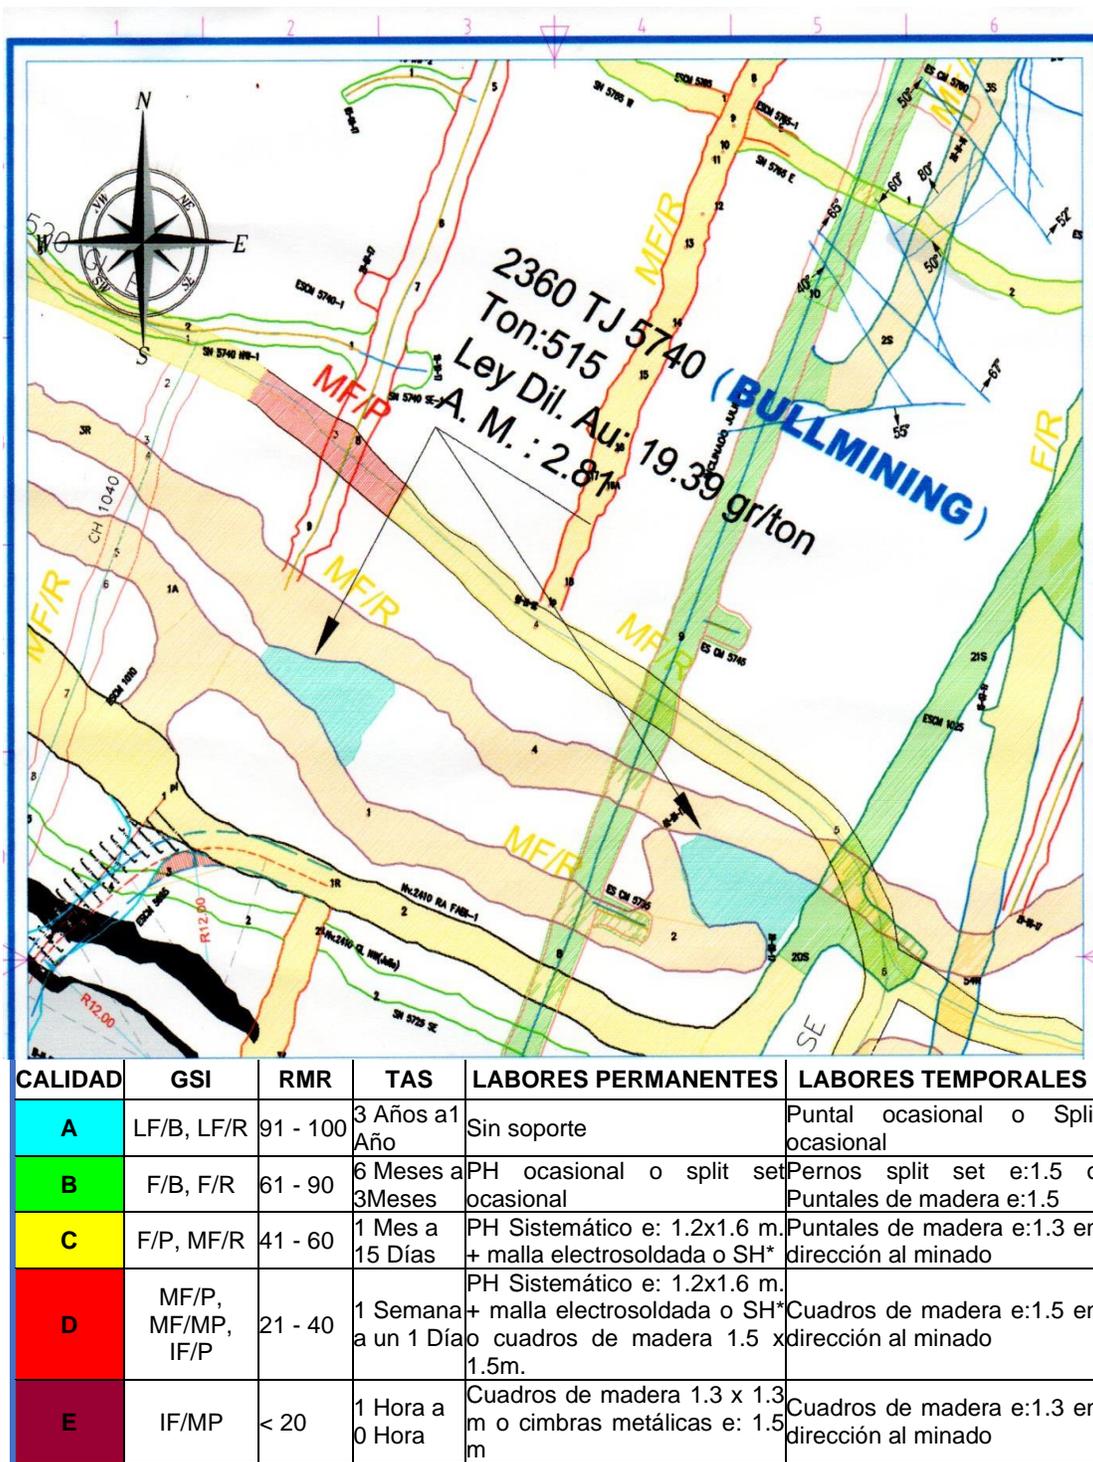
Plano Geomecánico Estructural – Veta Julie.
